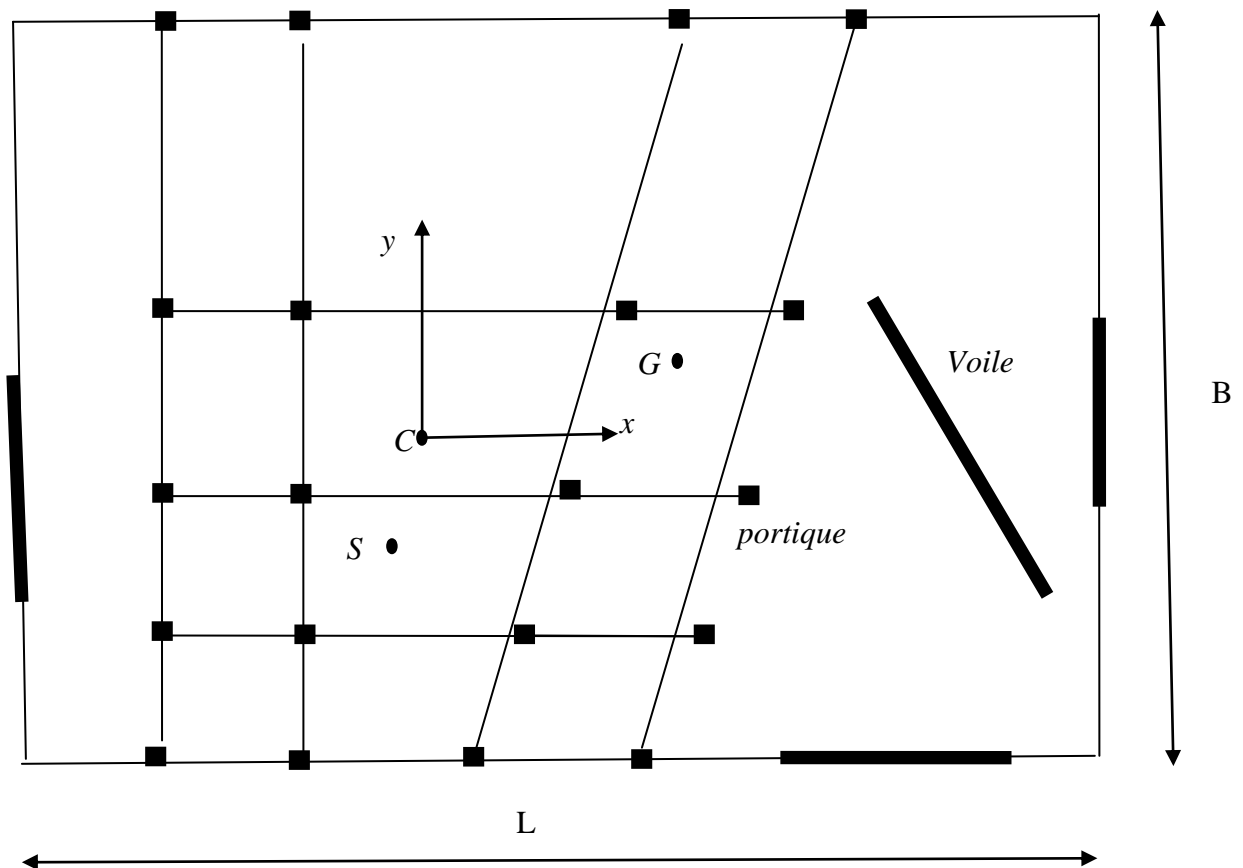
Plancher type d'un bâtiment asymétrique contreventé par des murs voiles et portiques
